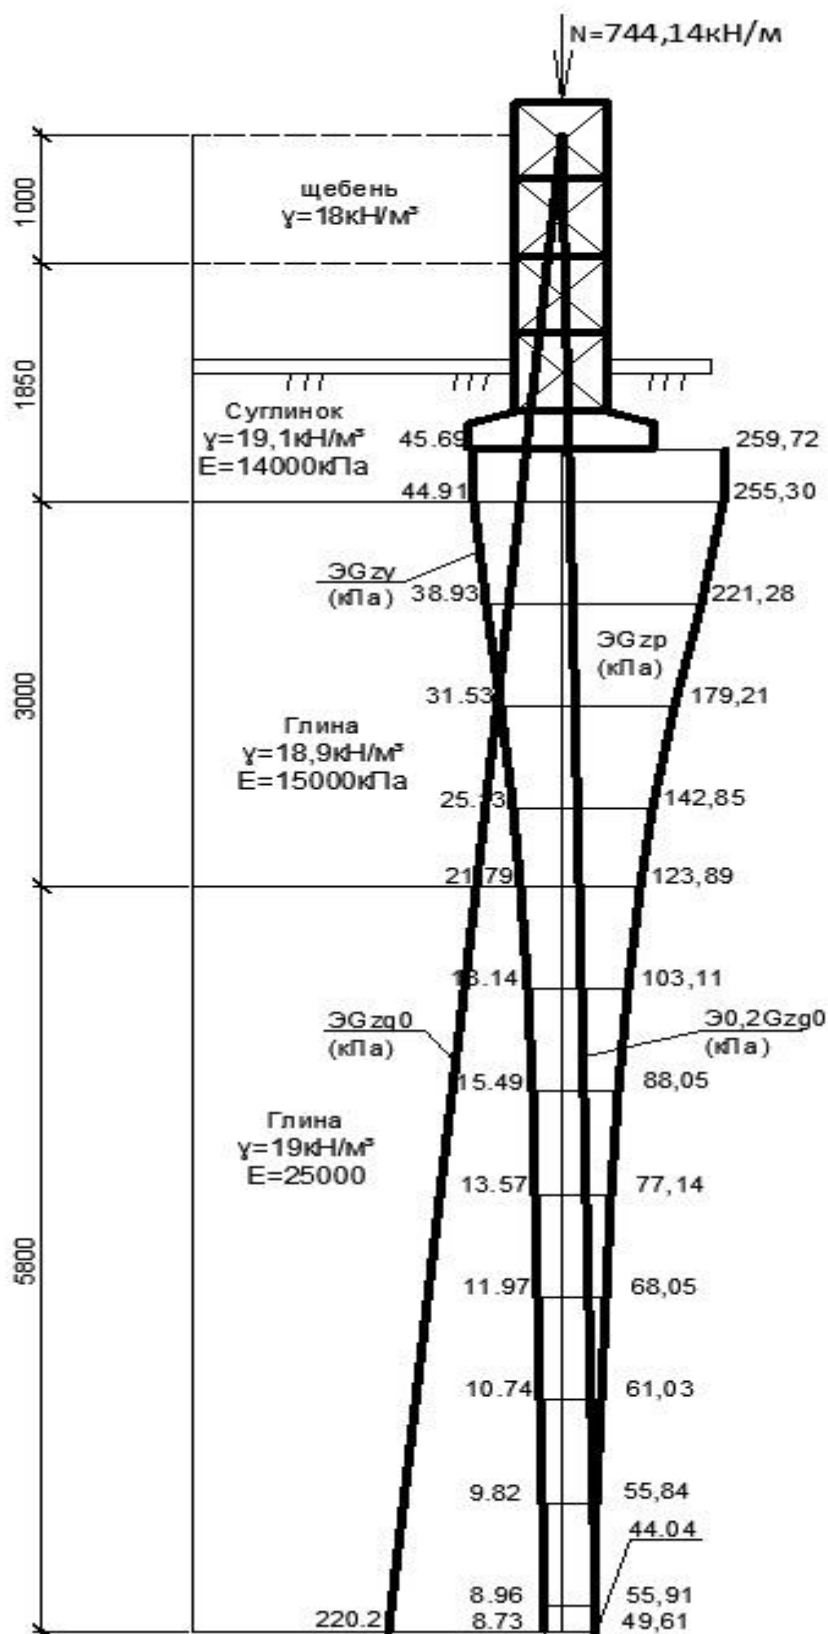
Схема к определению осадок фундамента «13» – «14»/«К»
